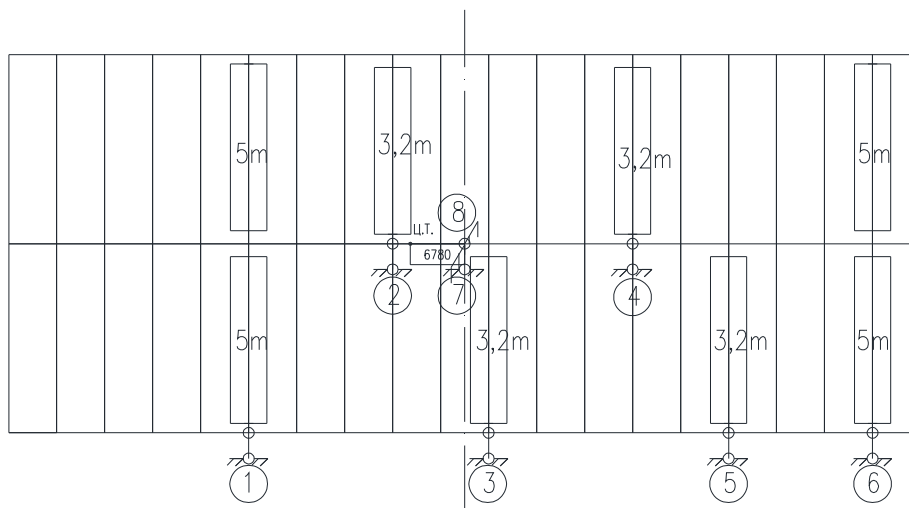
Схема расположения расчетных точек и мостовых кранов на плане здания
